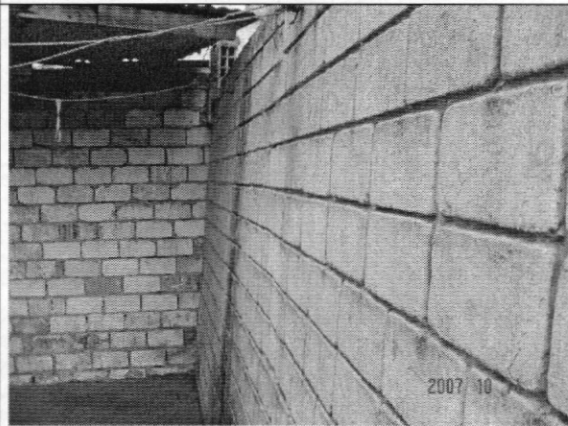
Pérdida de verticalidad del muro de lindero lateral
